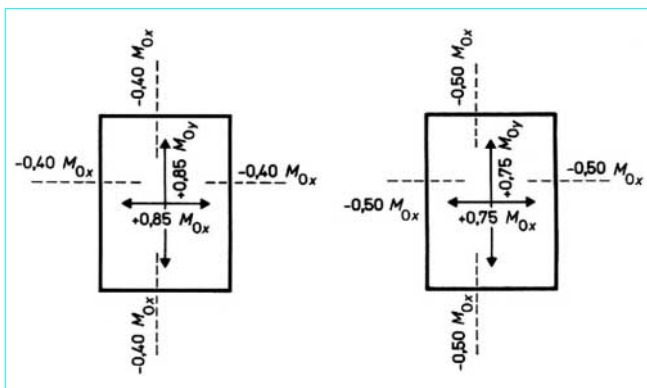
Répartition des moments en travée et sur appuis dans les panneaux de dalle rectangulaires
